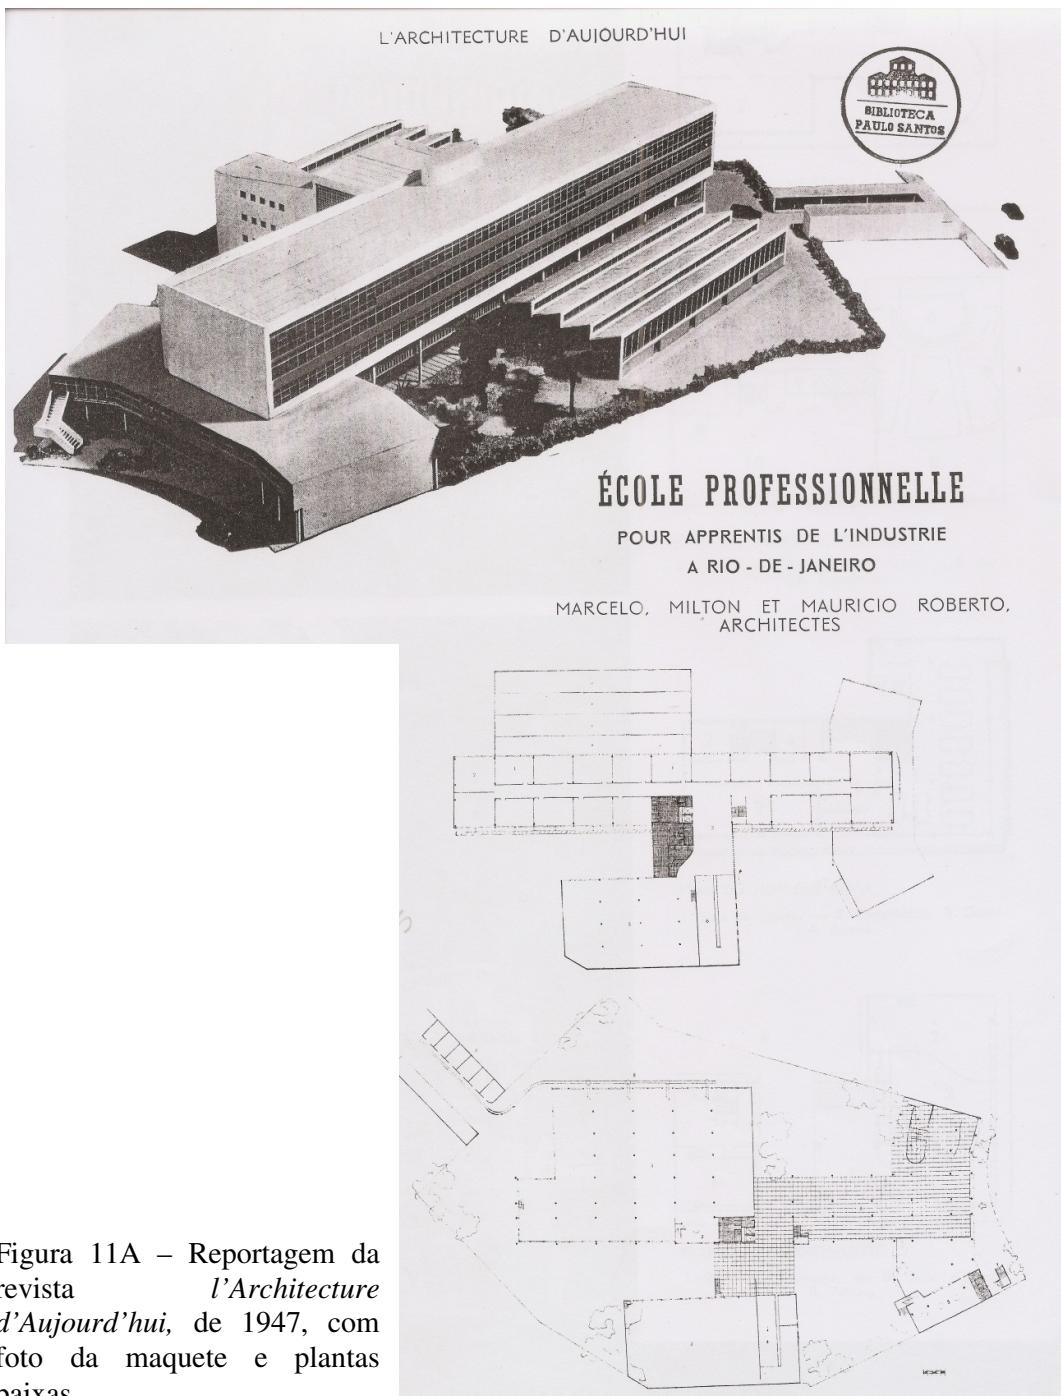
A – Reportagem da revista *l'Architecture d'Aujourd'hui*, de 1947, com foto da maquete e plantas baixas
